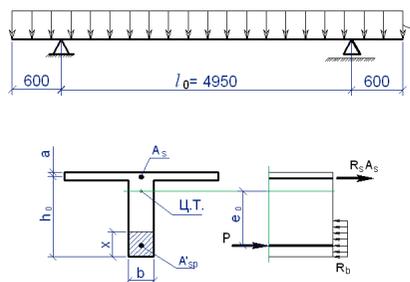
К расчету предварительно напряженной панели на монтажные нагрузки. а — план; б, в — расчетные схемы
